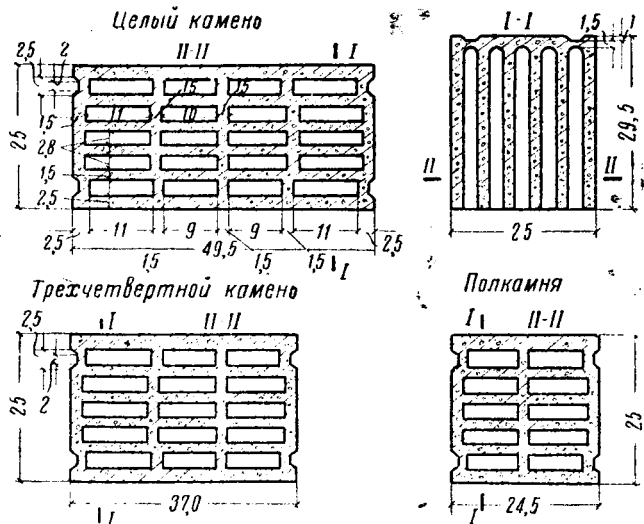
Стеновые камни: шлакобетонные, гипсовые и гипсобетонные
